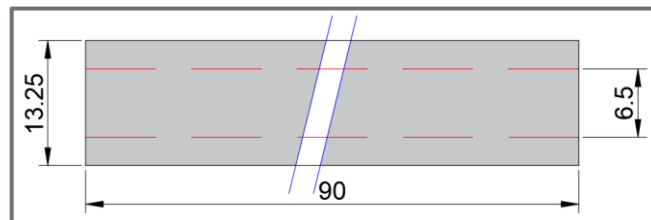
Vue en plan de la dalle de la Travée intermédiaire
